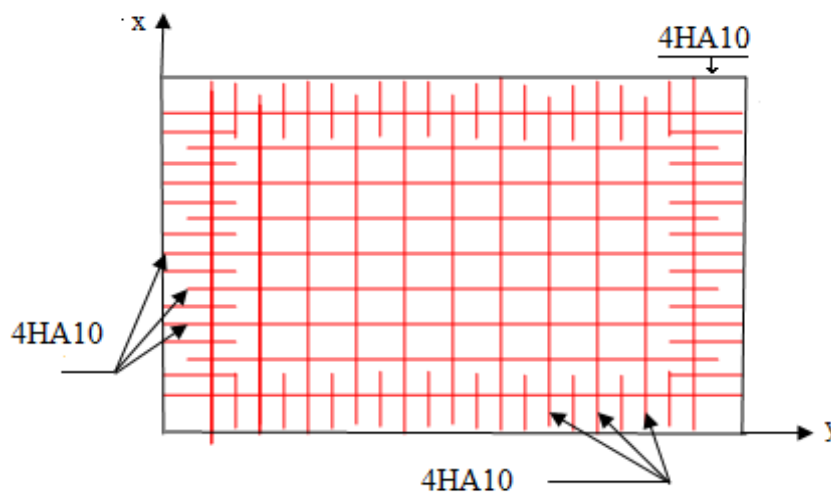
Schéma de ferrailage de la dalle inférieure.
